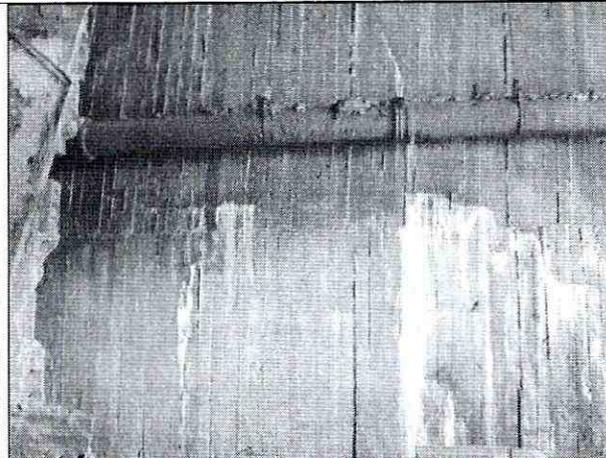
Fisuras y evidencia de filtraciones en la pared del costado sur del tanque de almacenamiento.
